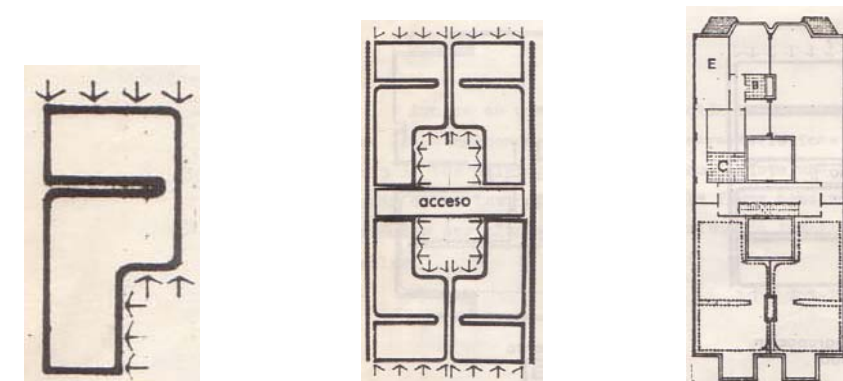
Bloque de viviendas entre medianeras con patios interiores (4 viviendas por planta)
